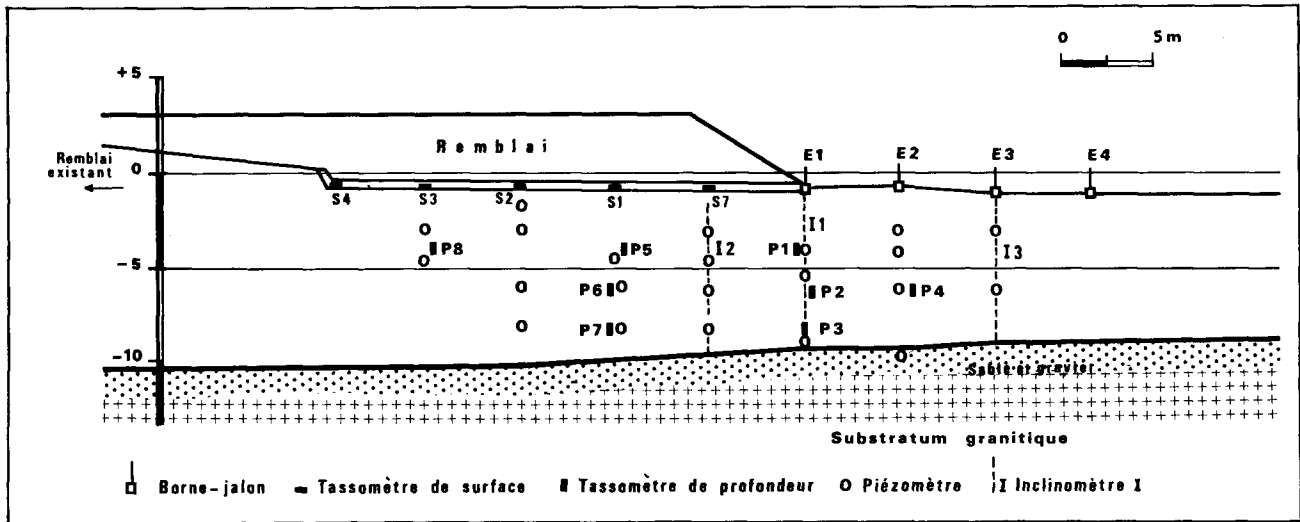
Coupe dans le plan médian du remblai; implantation des appareils dans ce profil.
